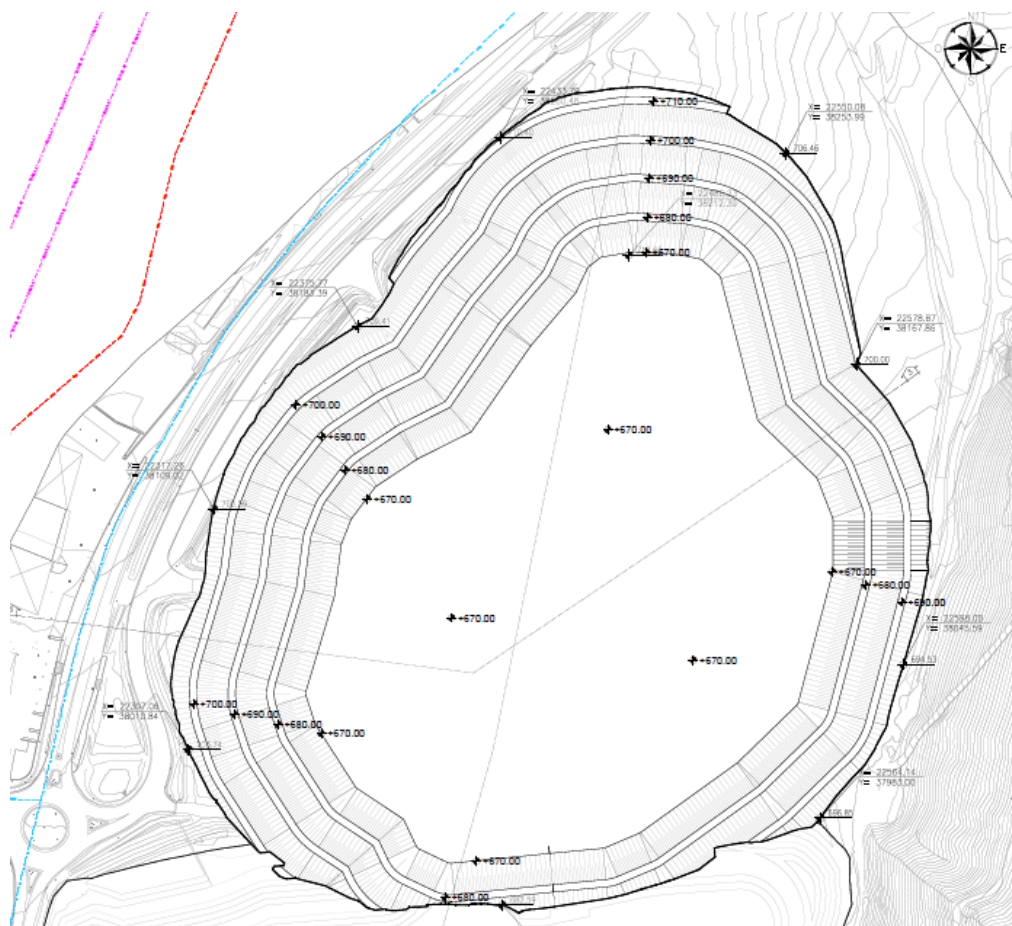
Stralcio planimetrico della cava Consorzio Dolomiti-D
